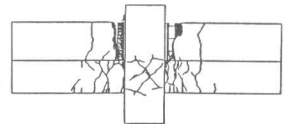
No.6(一面せん断型目地) 最終ひび割れ状況
